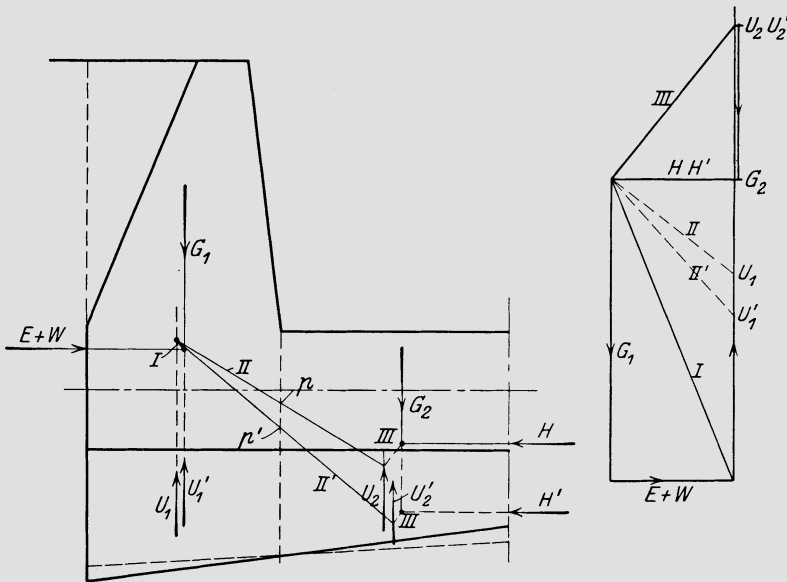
b. Statische Untersuchung des Falles: Sohle an den Enden gleichmäßig nach unten durchgebogen.
